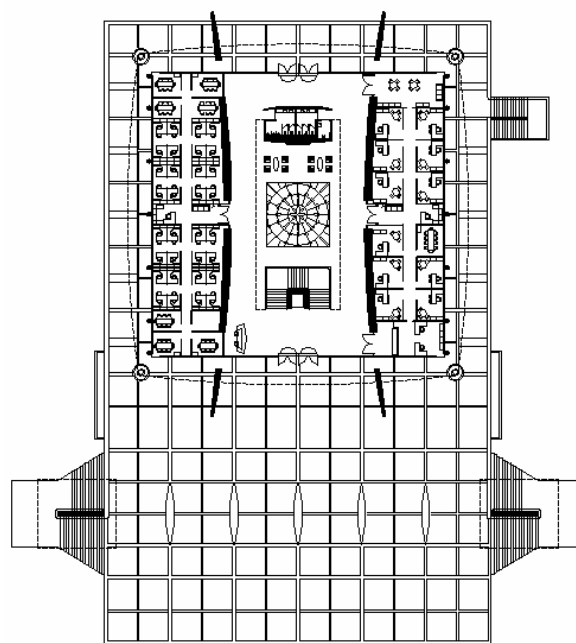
Planta pavimento térreo do edifício da Pós-Graduação Unicnp (fonte: MCA, 2006).
